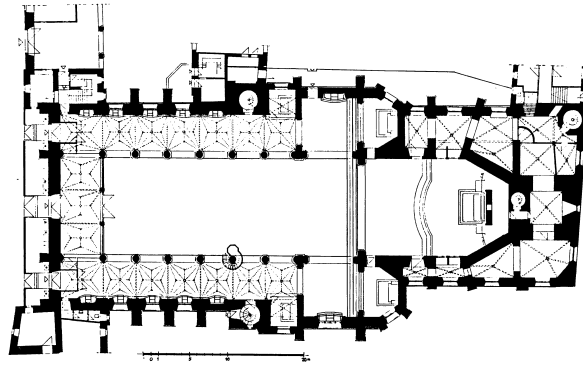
Köln, St. Mariae Himmelfahrt. Grundriss (Jesuitenkirche 1982, Abb. 17)
